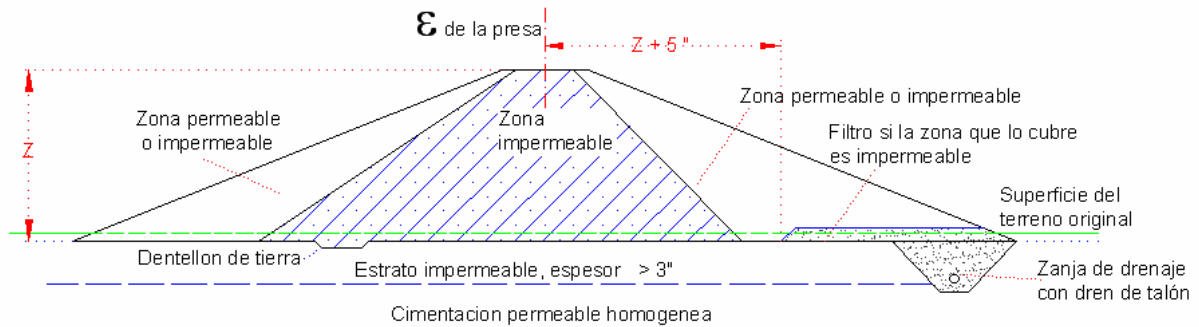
Estrato superior impermeable atrevasado por una zona de drenaje
